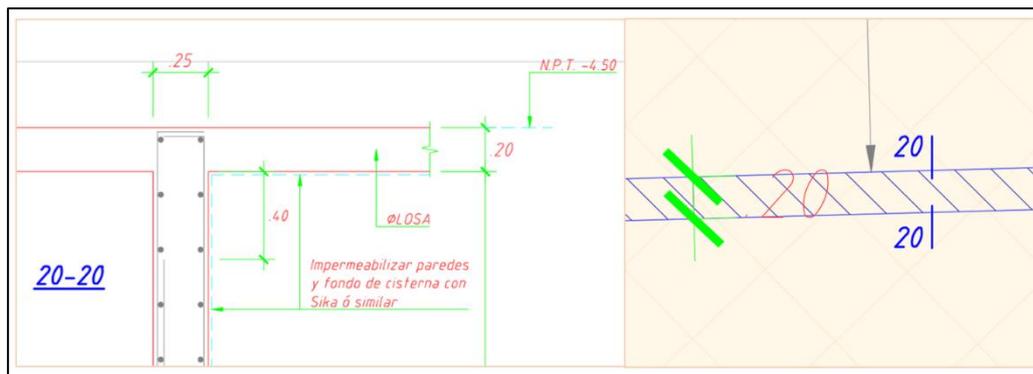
Vista en corte y en planta del muro en el corte 20-20
